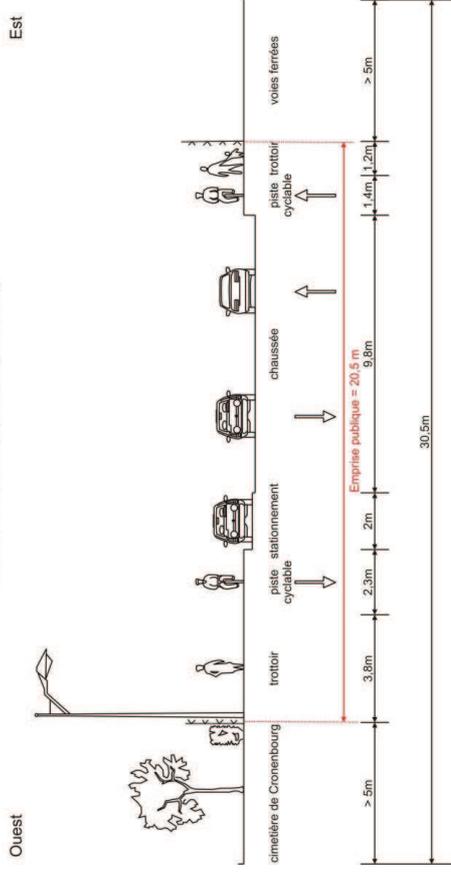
Situation existante (coupe 20) route de Hochfelden
